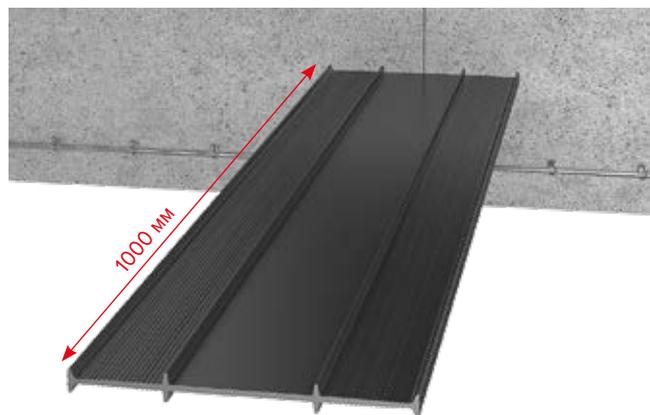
Выпуск гидрошпонки за блок бетонирования
